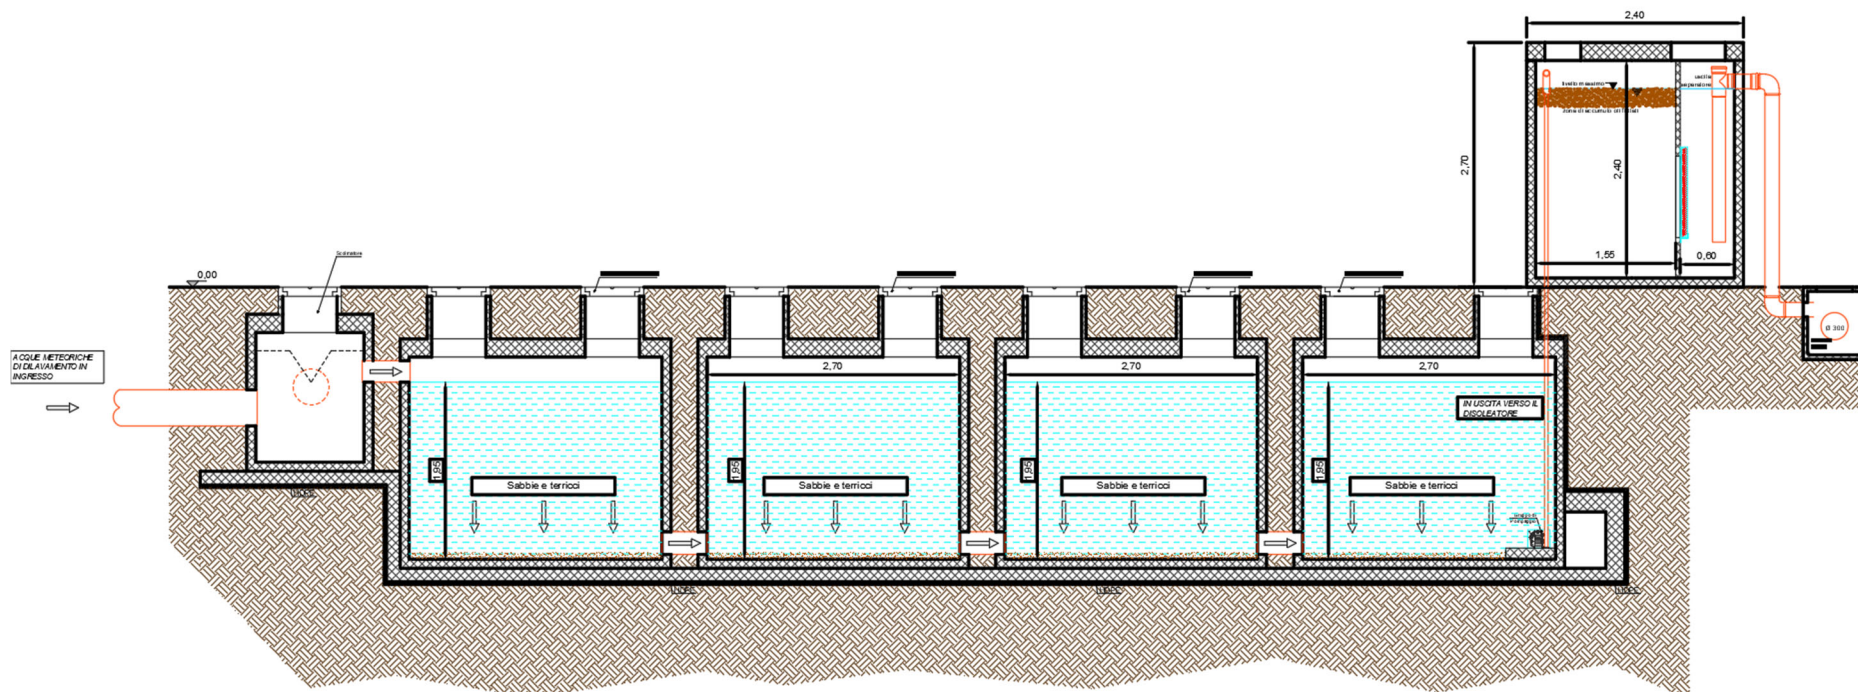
Sezione impianto trattamento acque di prima pioggia
